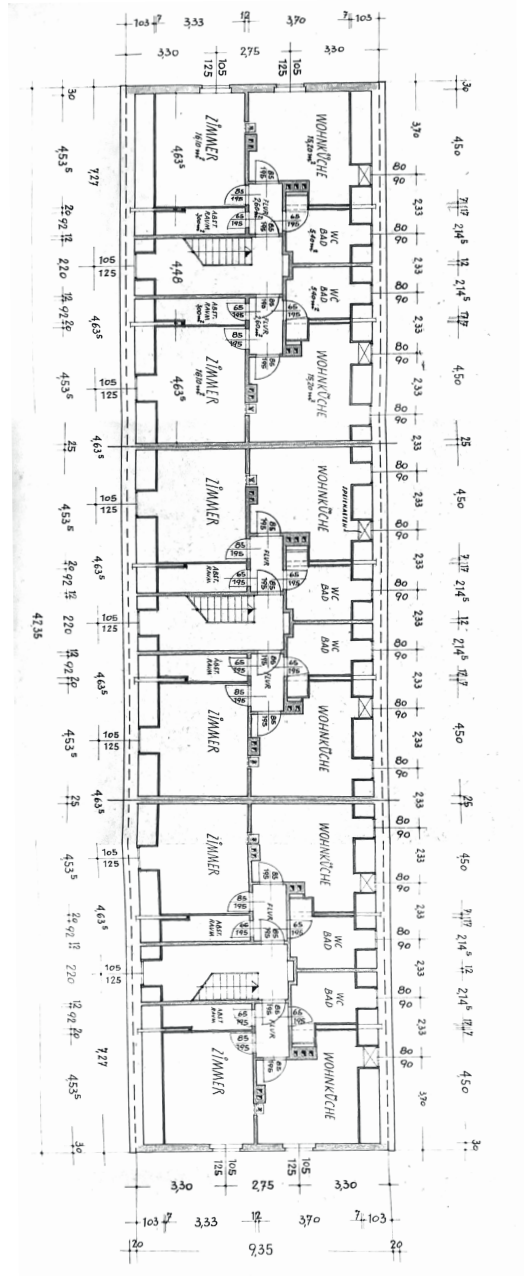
Büro Herbert Rimpl, Auerlingstraße 17-21, Grundriss Erdgeschoss
